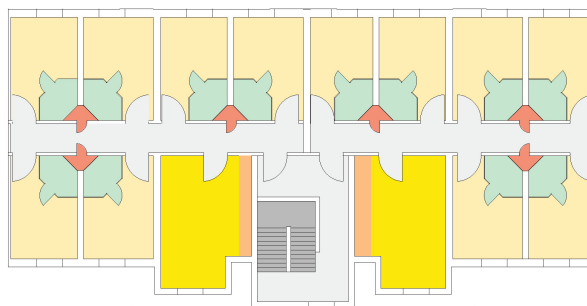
Eco Residence Town Houses. Schemat rzutu parteru i kondygnacji powtarzalnej. Opracowanie Mokrzecka M.
